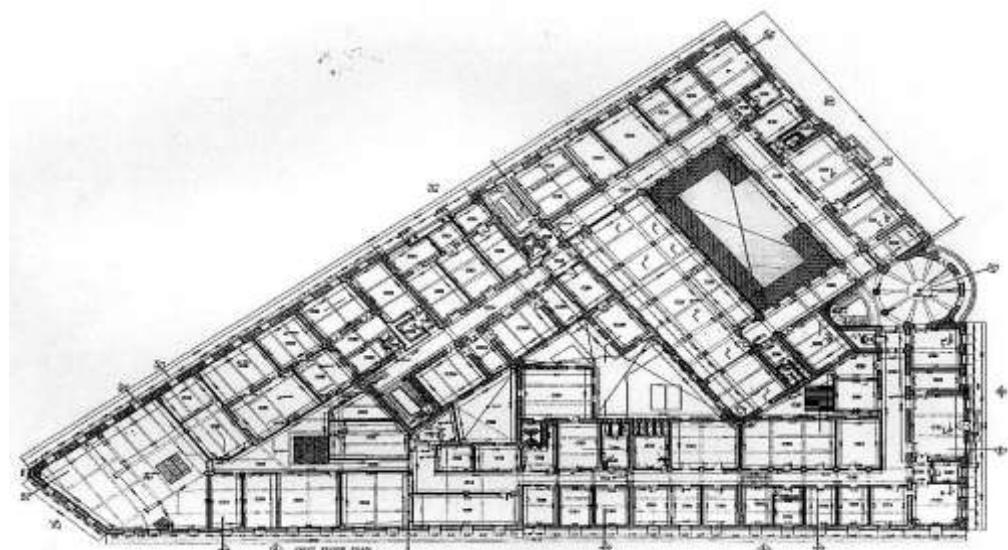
المسقط الأفقي للدور الأرضي أو الأول وبه توزيع القاعات
